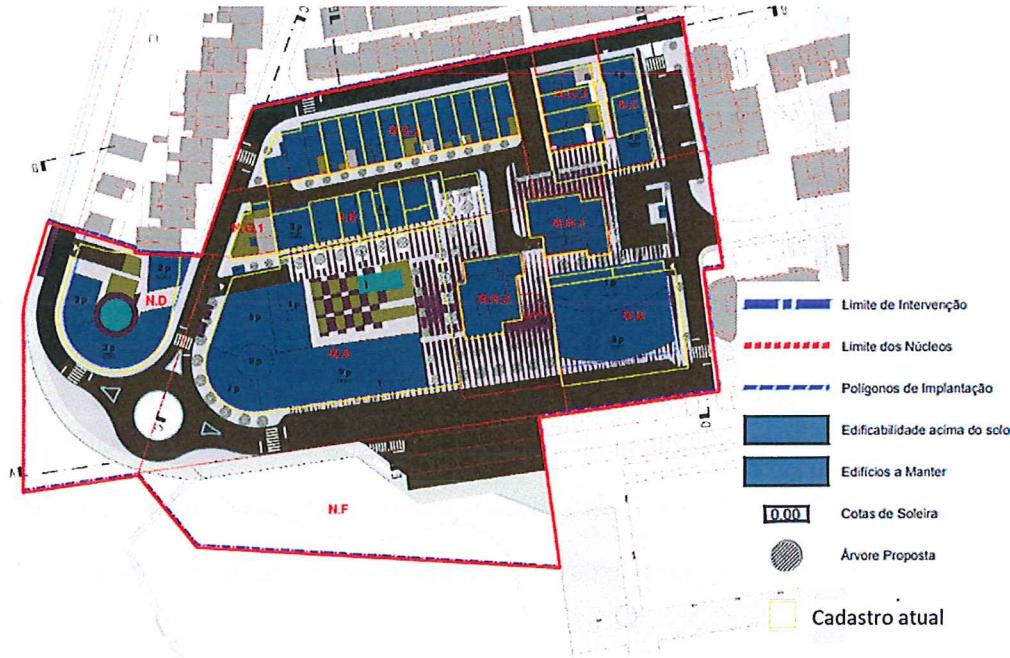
| Planta de Implantação do PP, com a sobreposição das parcelas cadastrais já registadas (limite a amarelo)
